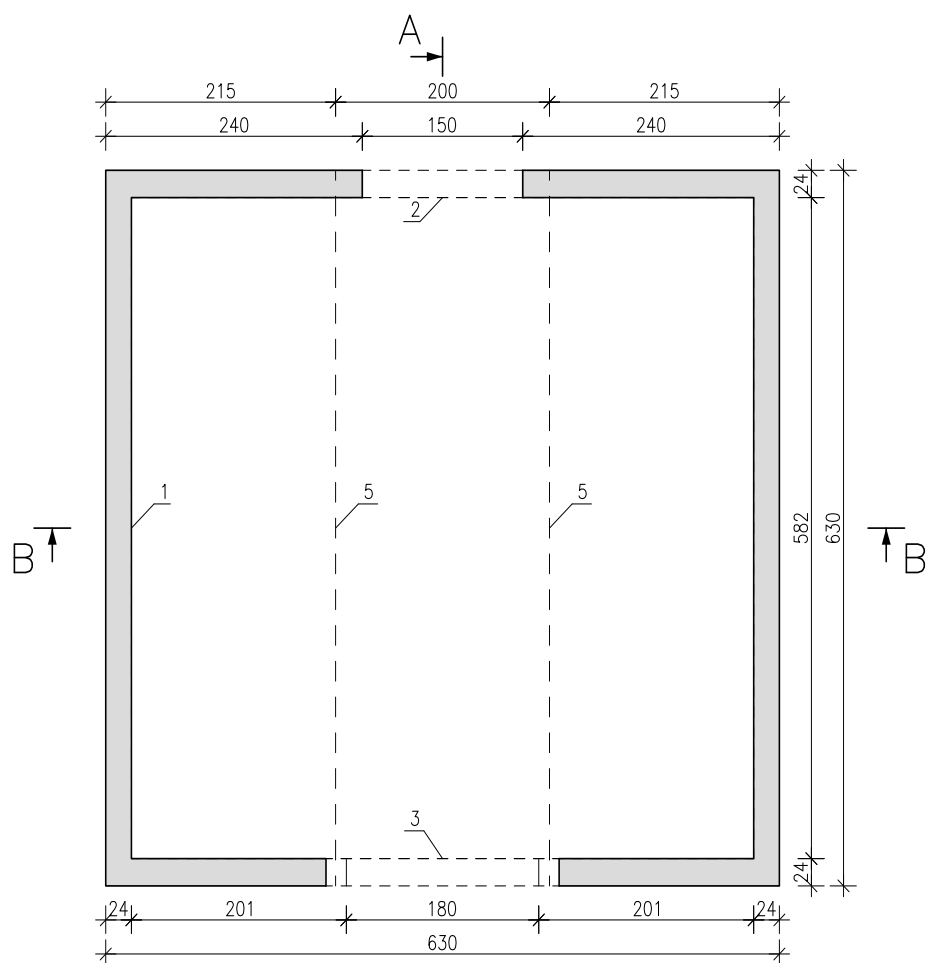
Widok modelu (1- strop TerivaPanel, 2- ściana z bloczków betonowych, 3- sprężone nadproże betonowe 2 x SBN 7,2/12/180, 4- prefabrykowana podbudowa betonowa)
